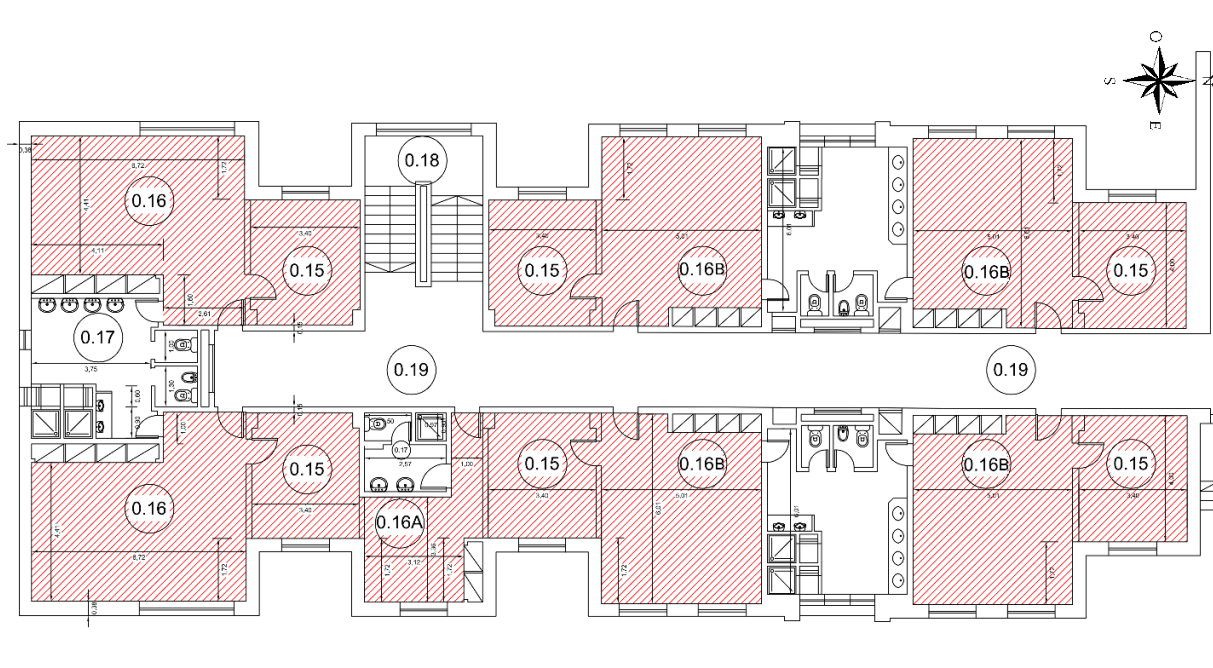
Planta do Piso 0, equivalente no Piso 1 e 2. Áreas úteis a climatizar a vermelho. Figura adaptada da planta do projeto de execução do edifício do alojamento de alunos da Academia Militar destacamento da Amadora.
